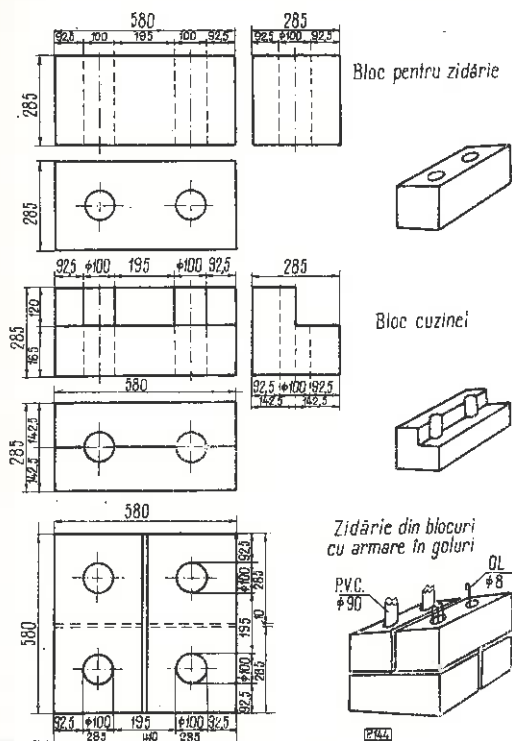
Blocuri prefabricate din beton simplu cu goluri, pentru zidărie (dimensiuni în mm).
